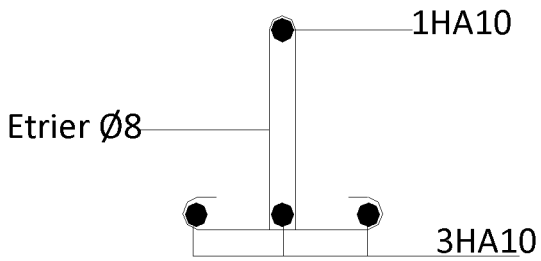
Plan de ferrailage de la poutrelle au niveau des travées.
